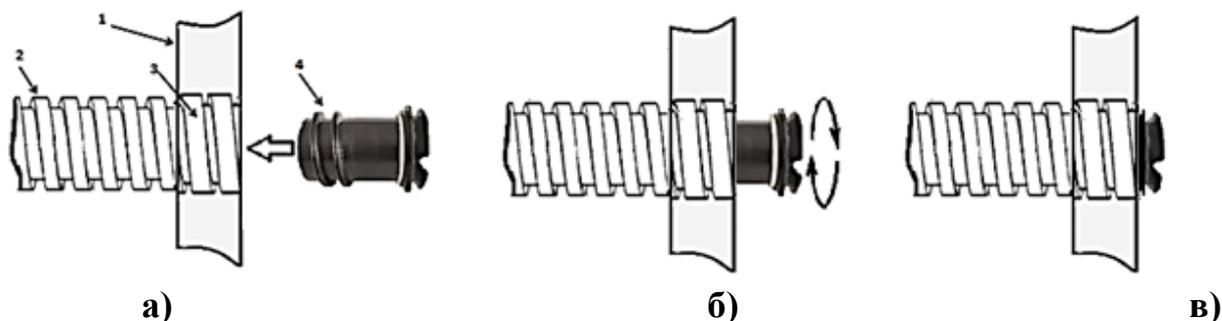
Установка внутренних заглушек в трубы ССД-Пайп, выступающие из стен внутри колодца:
